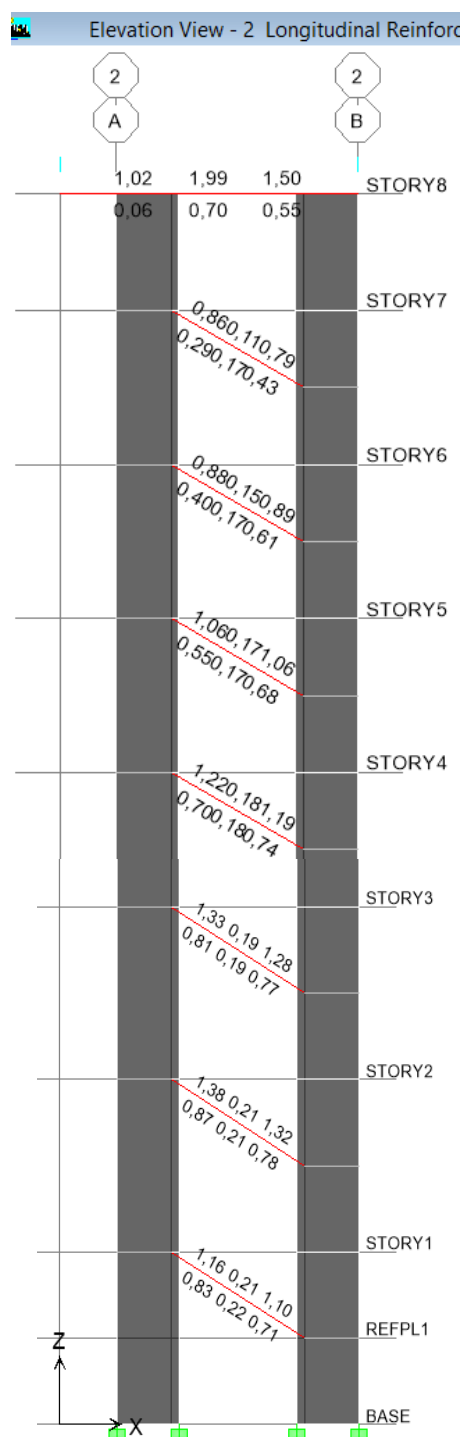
Acero en Vigas y Columnas en el Pórtico 2 – Escalera Emergencia Hospitalización 2- (CEC-2002)
